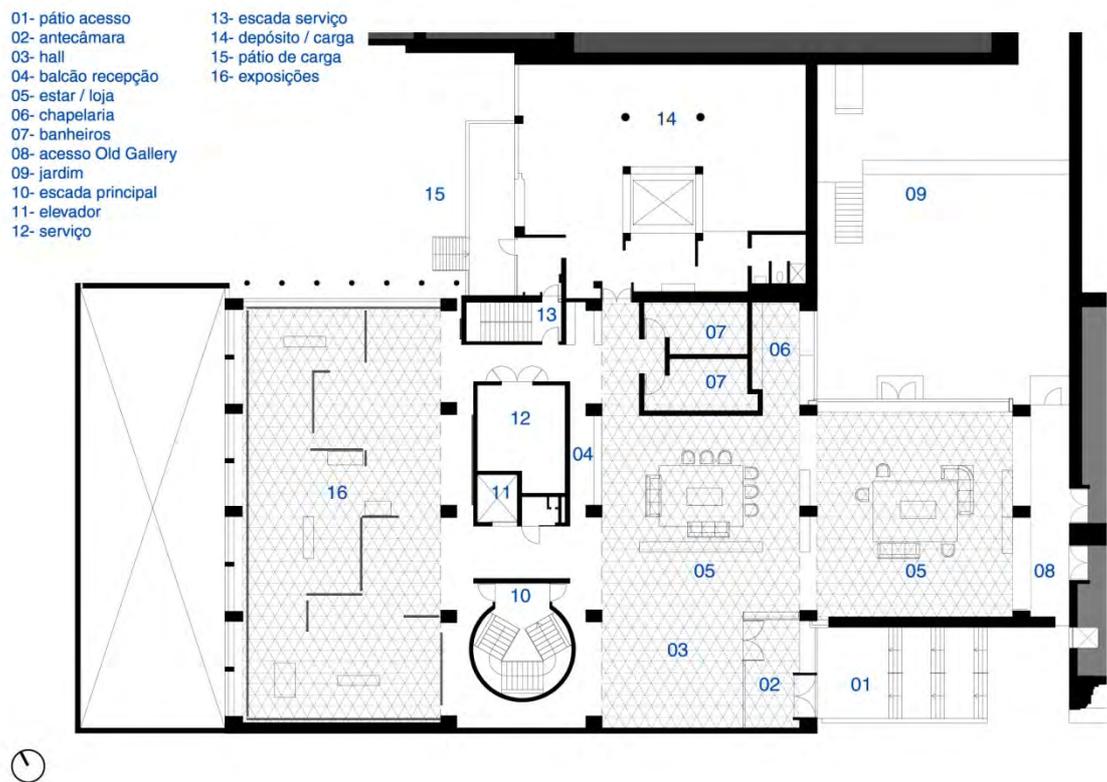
| Planta térreo YUAG [redesenho do autor]
